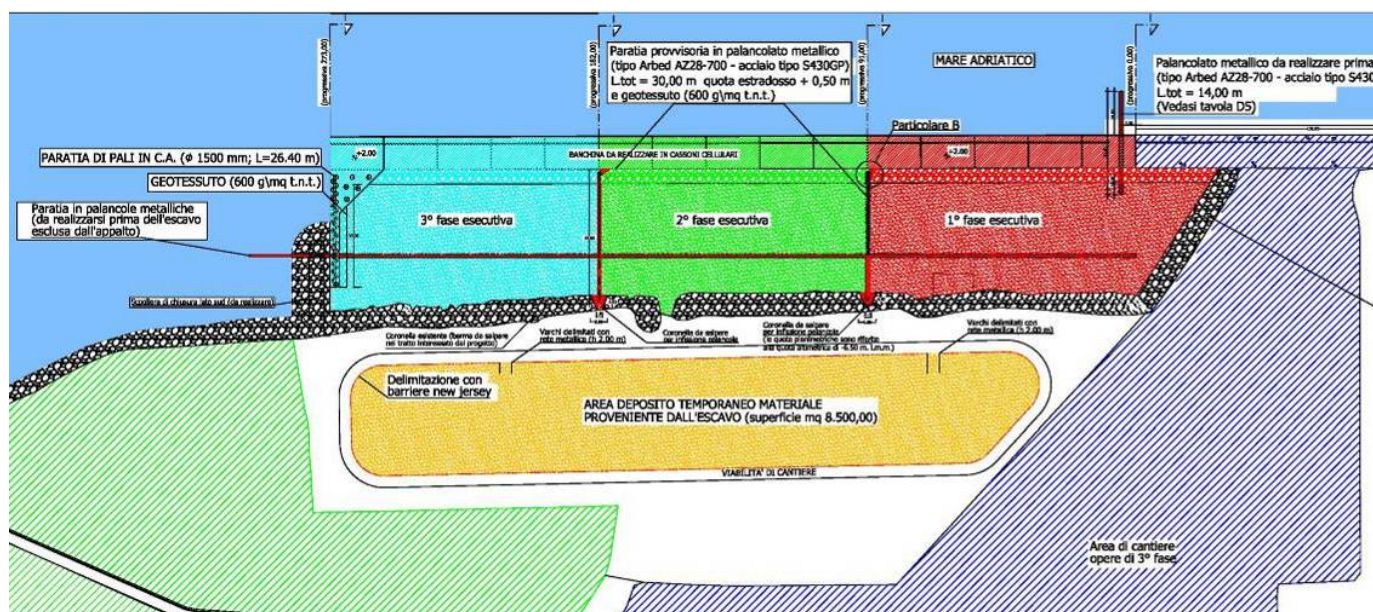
Dettaglio Tav. C4 – Planimetria fasi esecutive intervento di escavo
